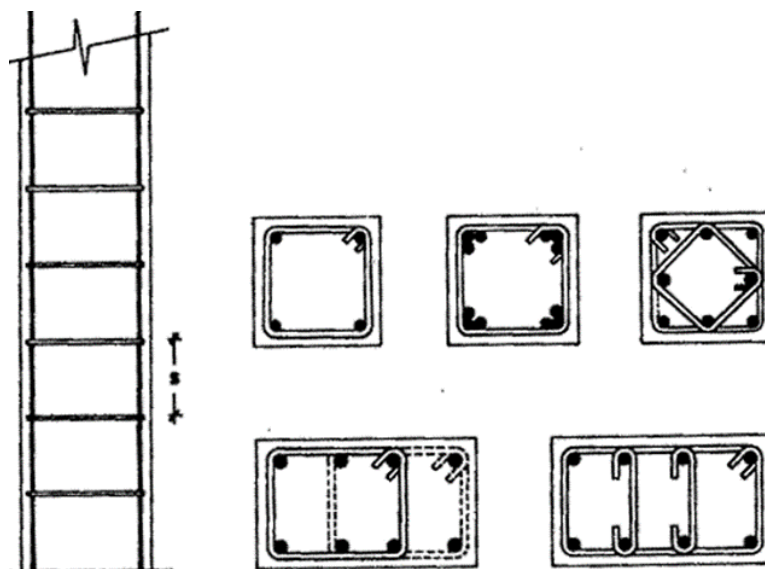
Secciones típicas de soportes de hormigón armado (fuente: Jiménez Montoya 2009)
